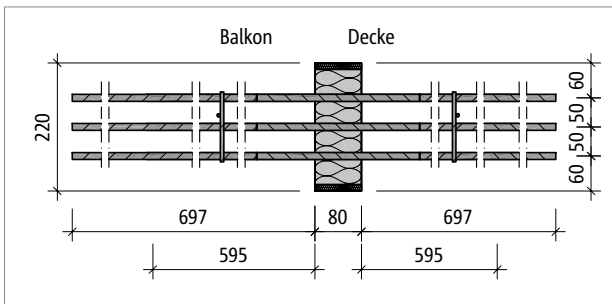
Schöck Isokorb® T Typ B: Produktgrundriss
